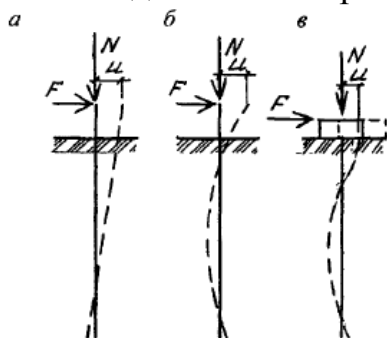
Расчетные схемы работы горизонтально нагруженных свай: а - жесткой; б - гибкой; в - гибкой, жестко заделанной в ростверк
